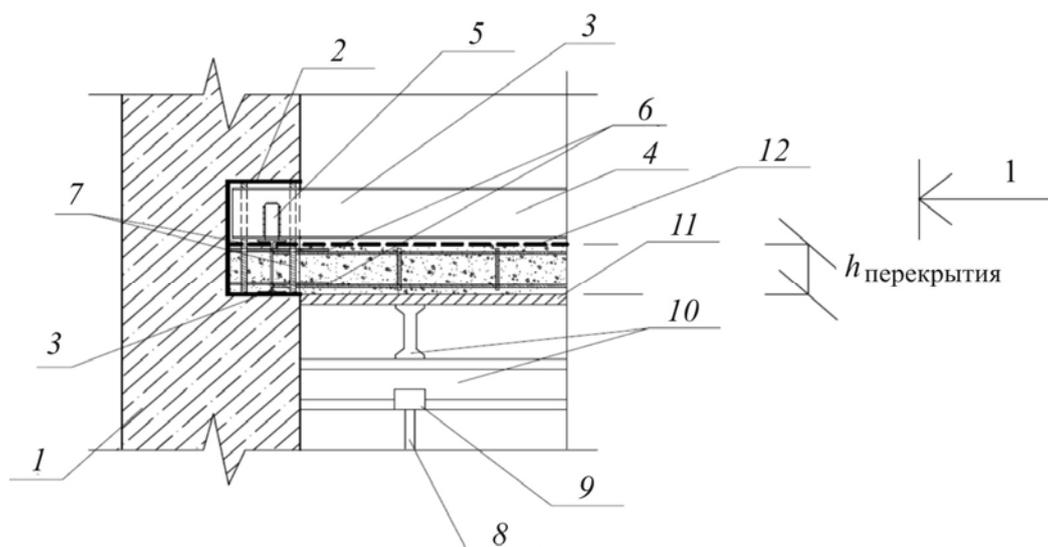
Поддержка плиты перекрытия: 1 — монолитная стена; 2 — оставленная при бетонировании ниша; 3 — двутавровая балка, подобранная по условию $h \geq h_n$, где h — высота двутавра, h_n — высота перекрытия; 4 — поперечная двутавровая балка на ширину пролета; 5 — раскос для устойчивости поперечной двутавровой балки; 6 — выпуски арматуры в монолитной стене, предусмотренные по предварительному расчету; 7 — продольные вертикальные арматурные стержни монолитной стены; 8 — телескопическая поддерживающая стойка; 9 — вилка телескопической стойки; 10 — деревянная балка (ригель); 11 — щиты опалубки (ламинированная фанера); 12 — поверхность монолитной плиты
